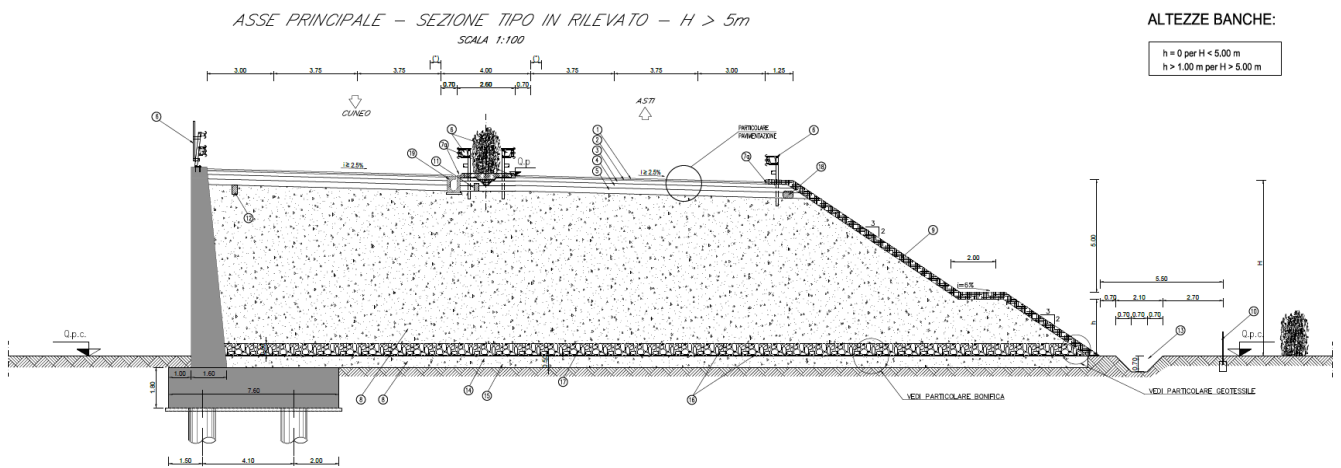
Asse principale: Sezione tipo in rilevato – $H > 5m$
